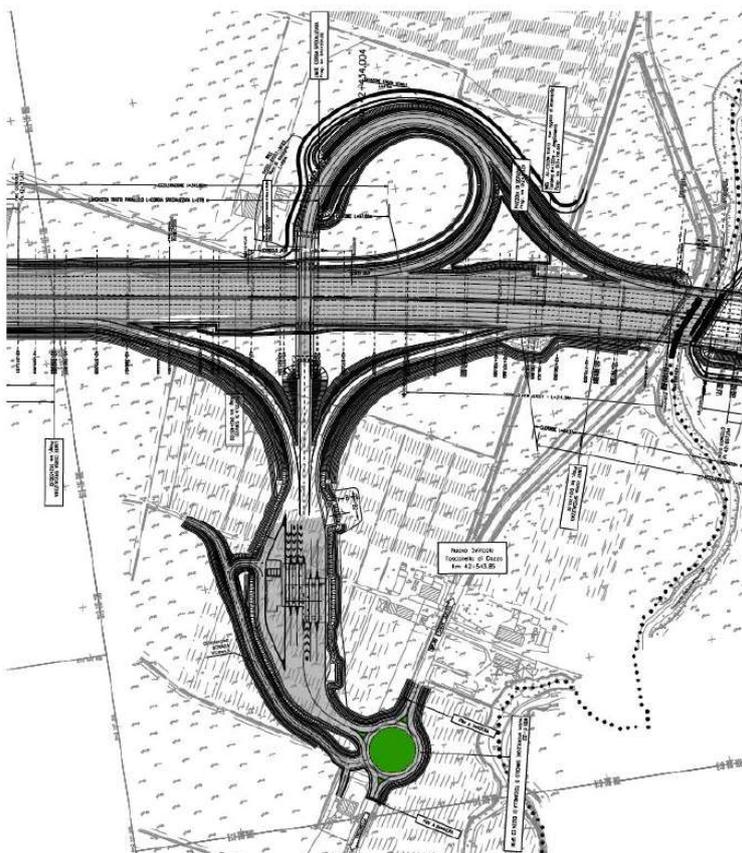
Stralcio planimetrico del nuovo svincolo di Toscanella
